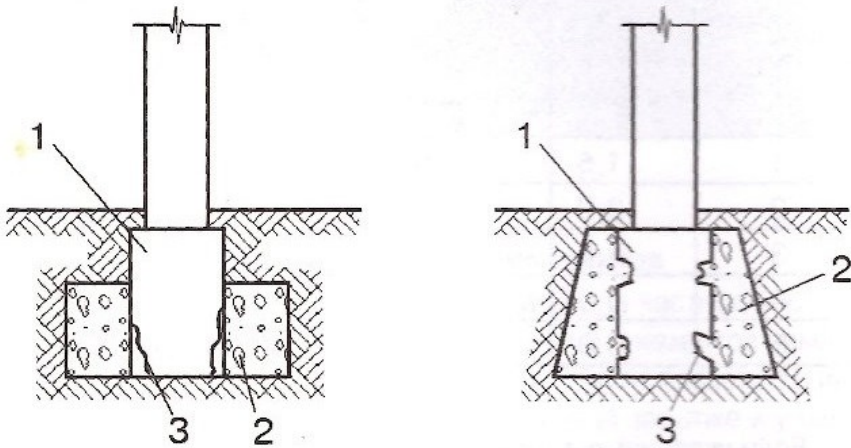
Схема посилення фундаментів бетонними обоймами:
